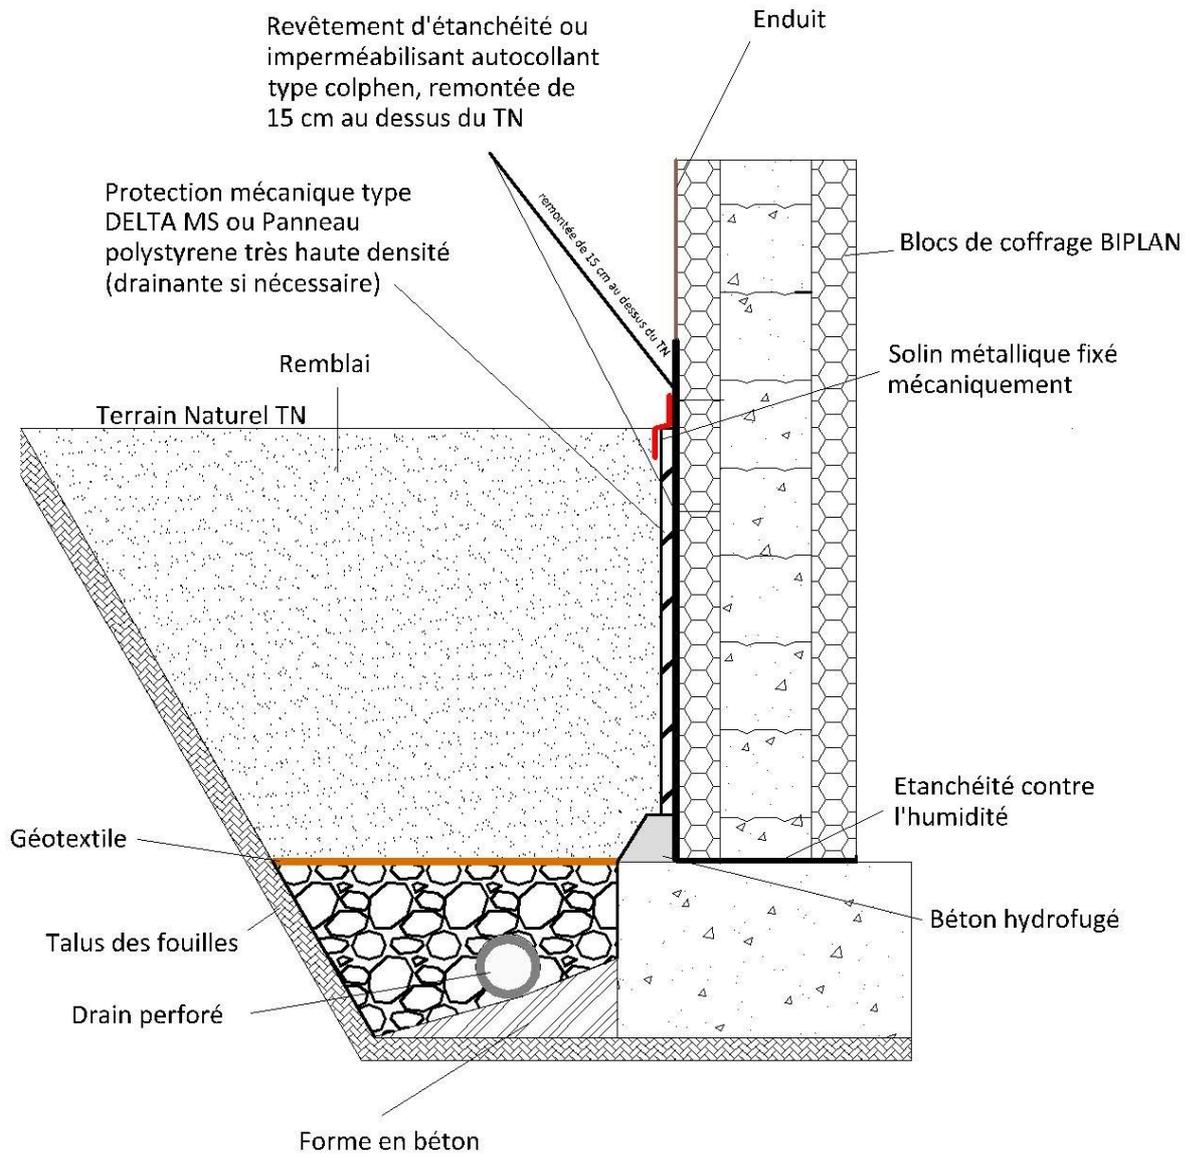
Schéma de principe de la mise en place d'un drainage et d'une étanchéité (suivant DTU 20.12)
